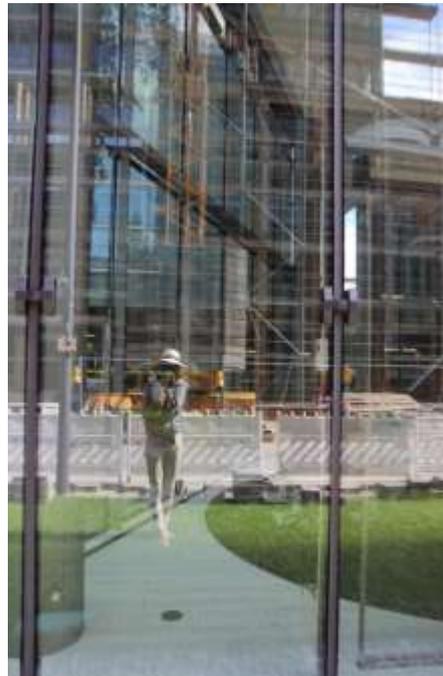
, 17. Highlight Towers Detailansichten (Fotos E. Wölf)
